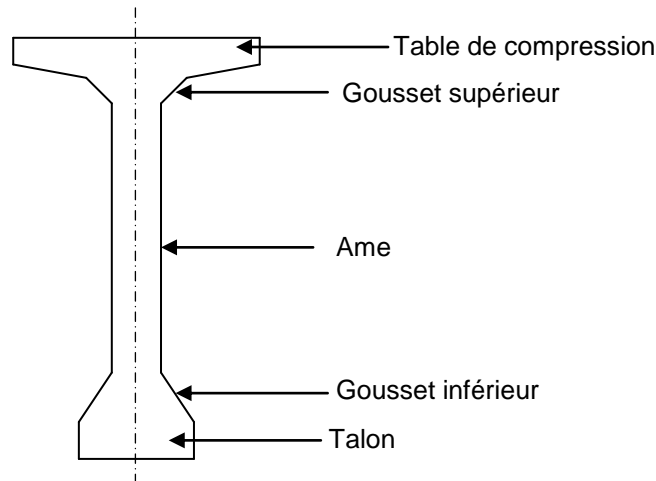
Terminologie et coupe transversale d'une poutre
